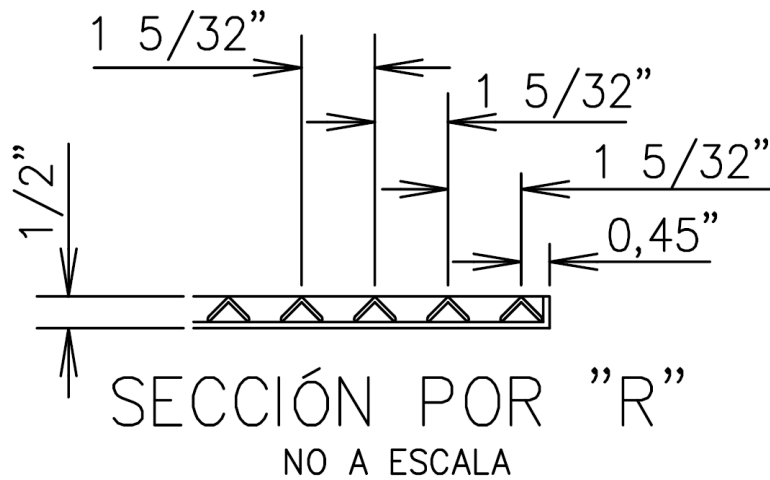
Parilla para soldadura de arco eléctrico
